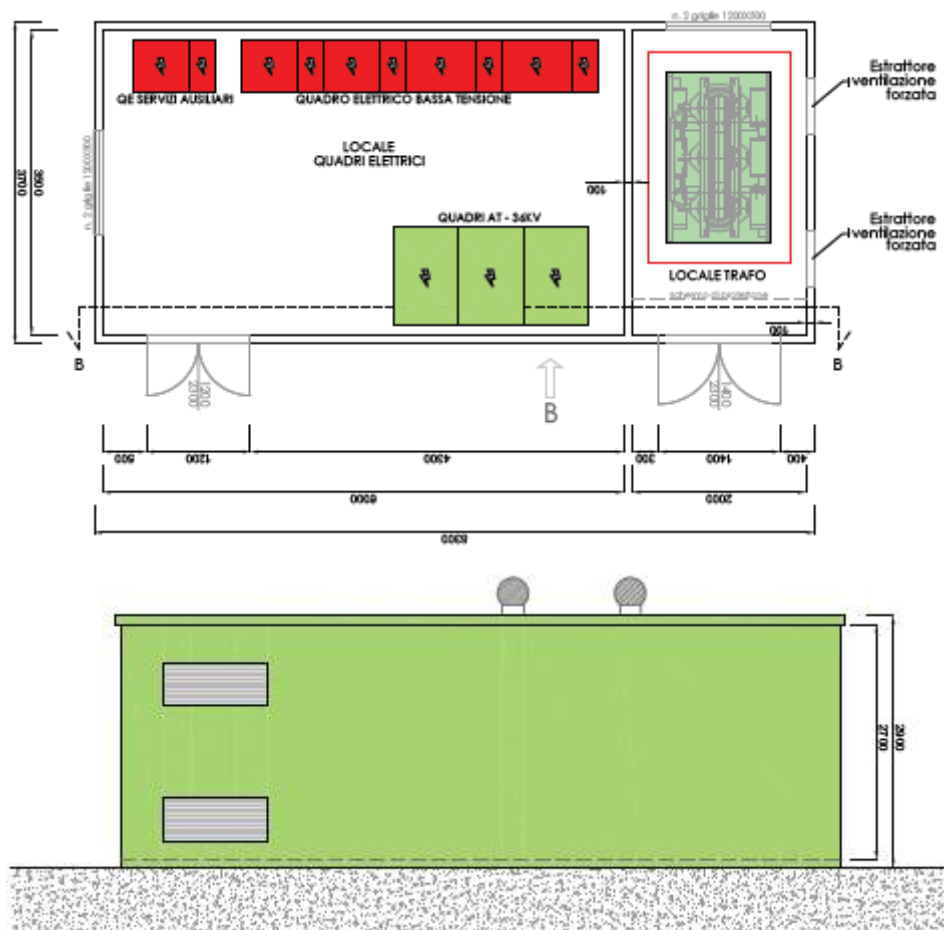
Pianta e prospetto cabina di trasformazione
